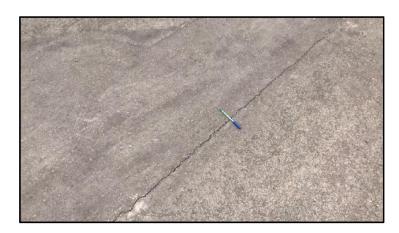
Fisura longitudinal Fuente: Elaboración Propia
